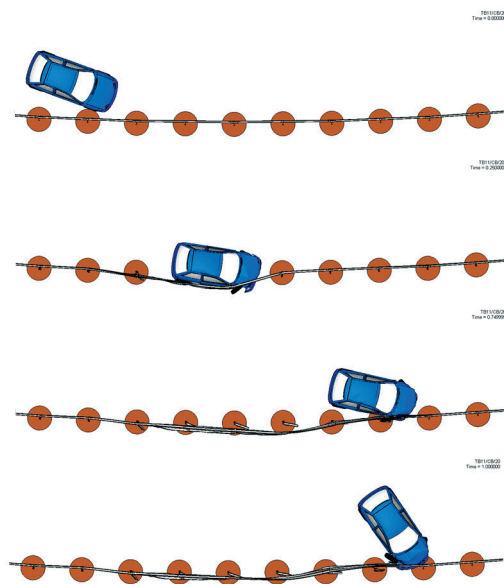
Animacja testu zderzenia TB11/SB/20 – widok z góry
